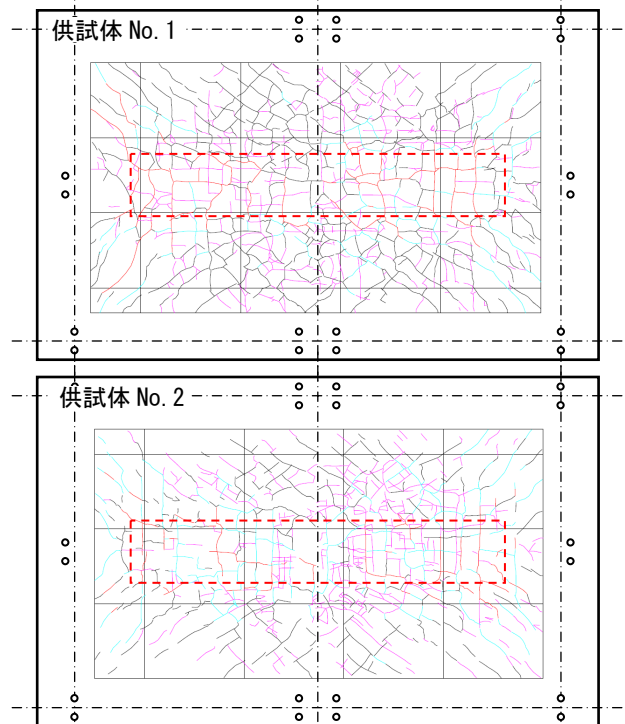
補強床版破壊後の底面ひび割れ発生状況
